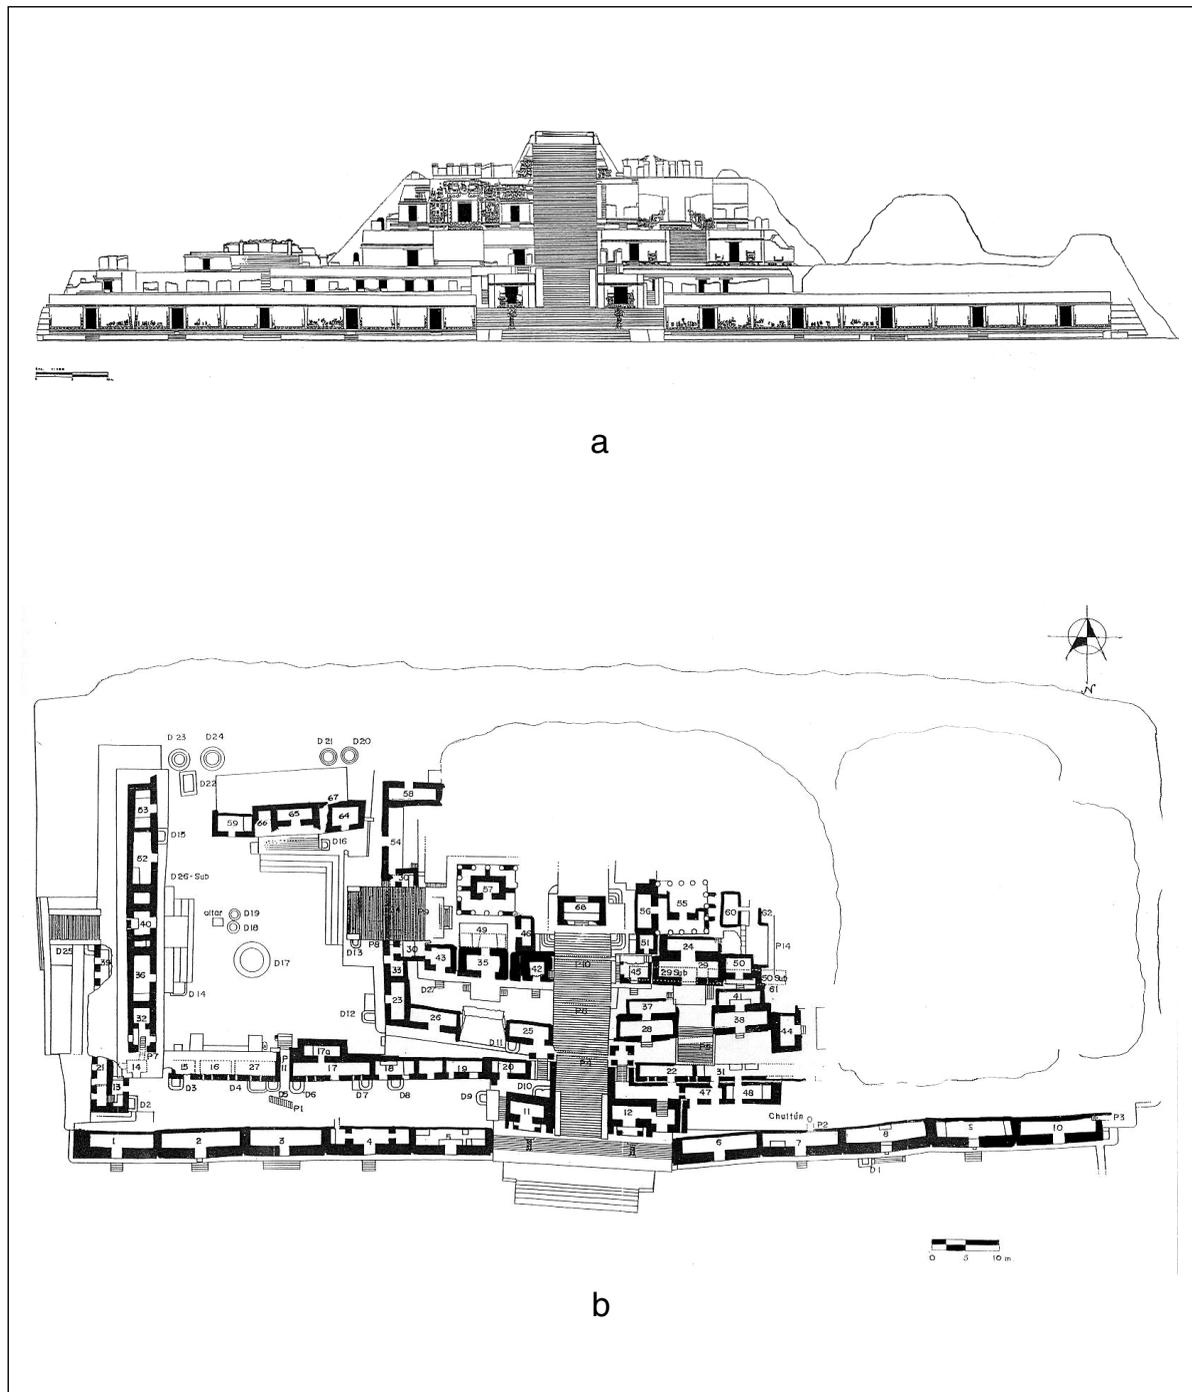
Ek' Balam, Estructura 1, Acrópolis: a) alzado sur; b) planta (según dibujos de V. Castillo).
